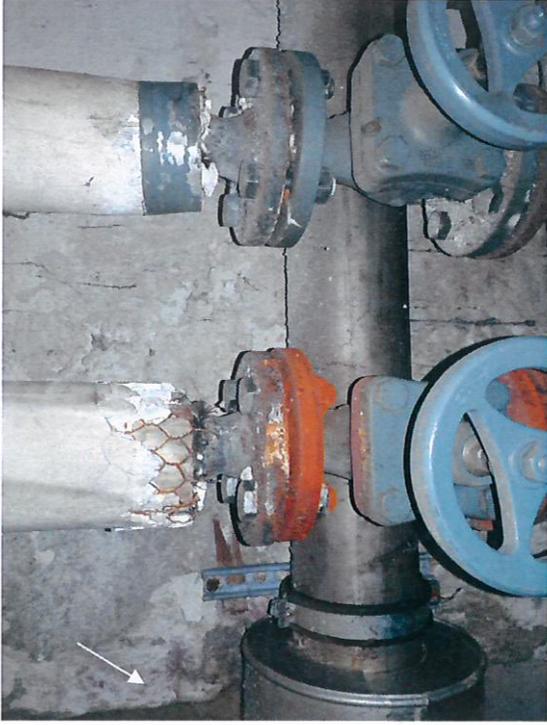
alte Rohrflansche (P 7) u. Rohrflansche der Heizung (Raum K19)
